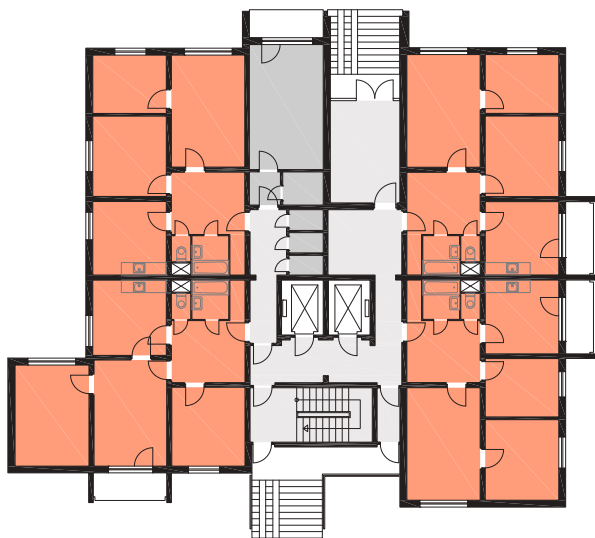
Konstrukční soustava VP-OS (Zdroj: panelaky.info)
